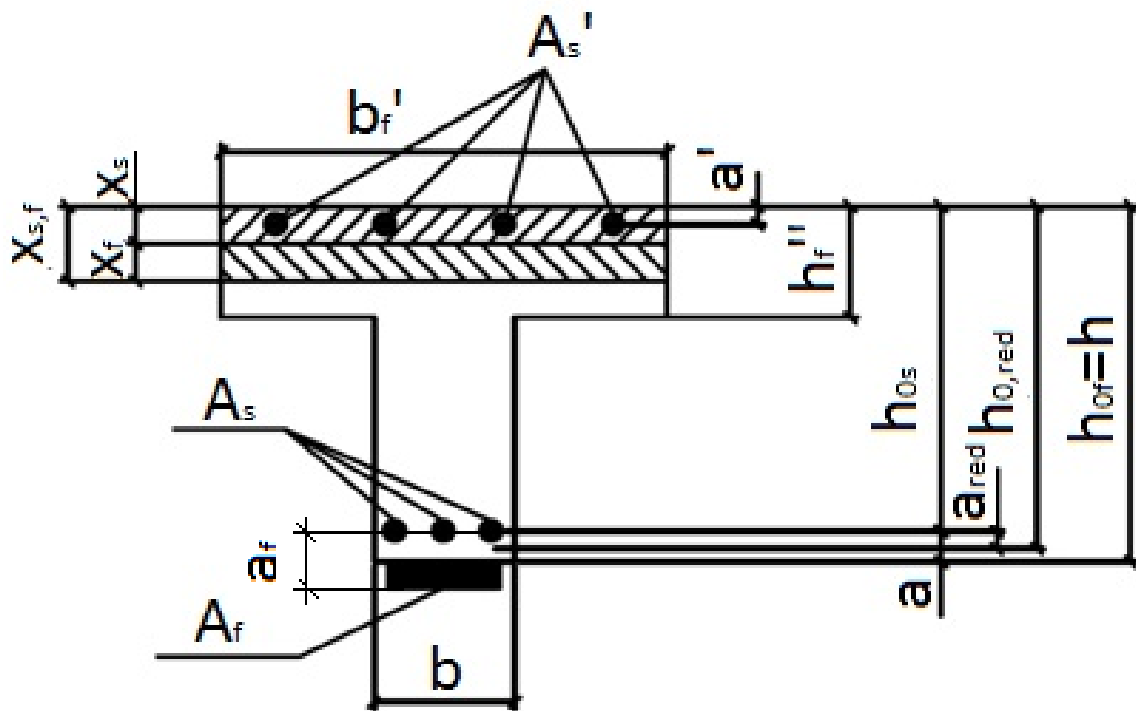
Расчетная схема для универсального метода расчета элемента таврового профиля по первому случаю ($x \leq h'_f$)
